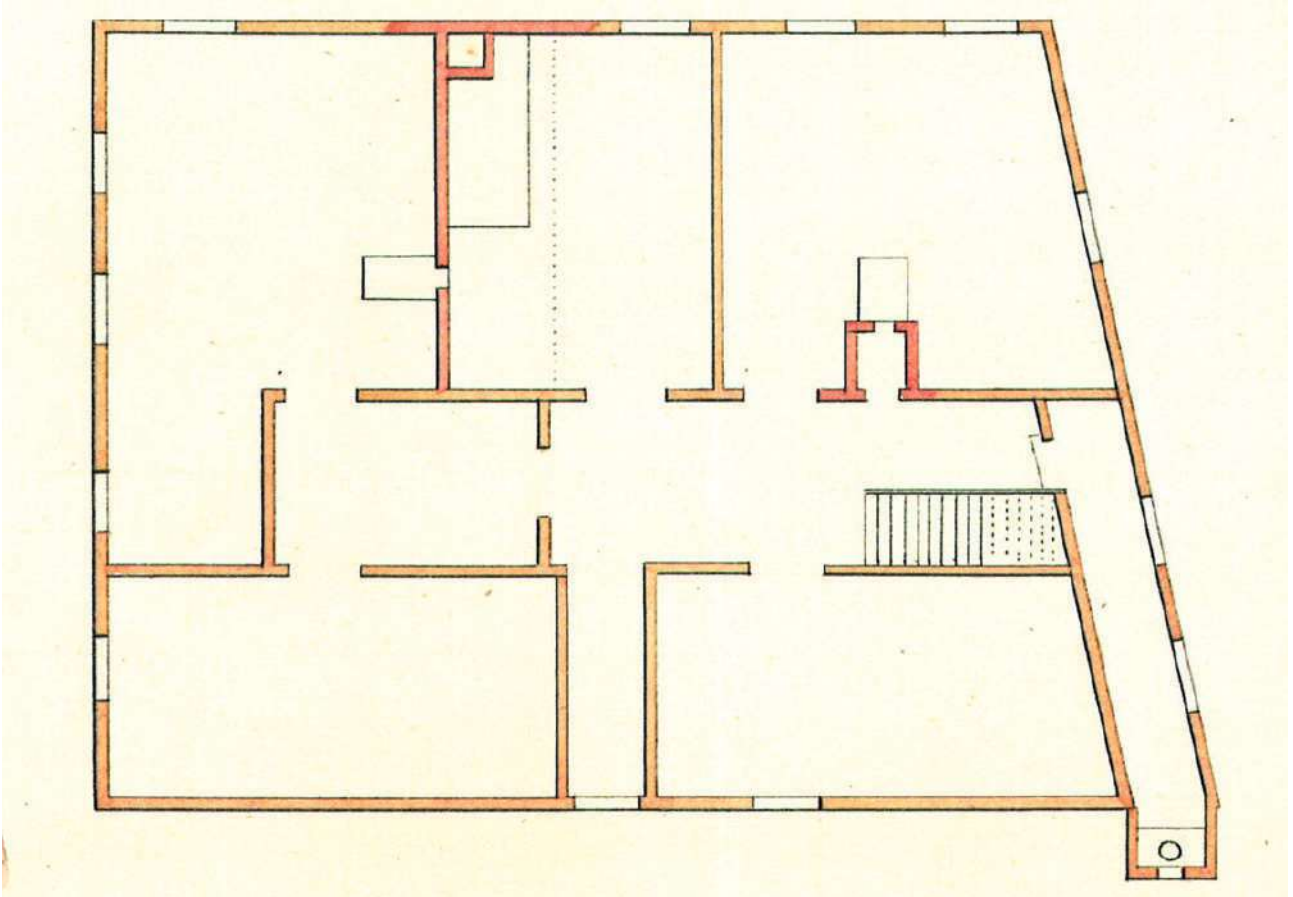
Bestandsplan des abgegangenen Kaplaneihauses, Obergeschoss, um 1820
